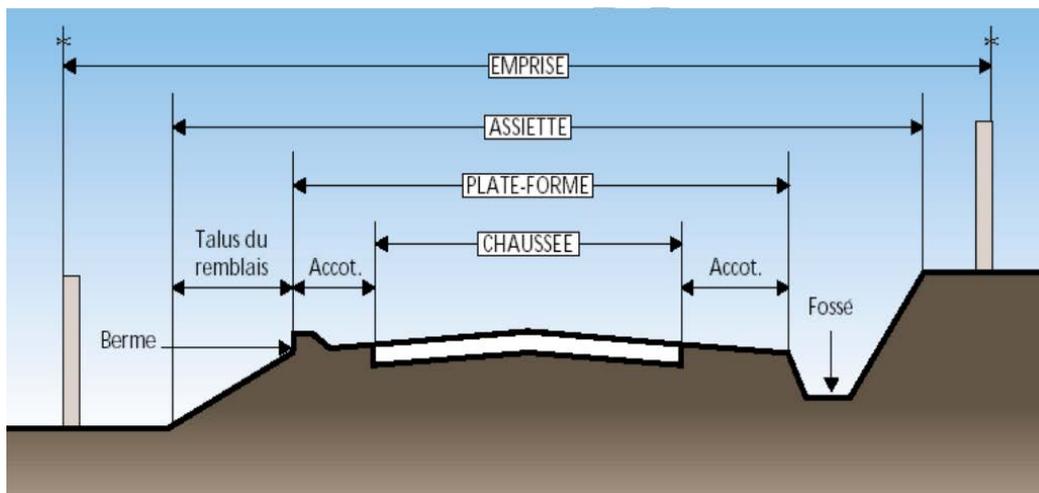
Profil en travers type d'une route bidirectionnelle [6]
